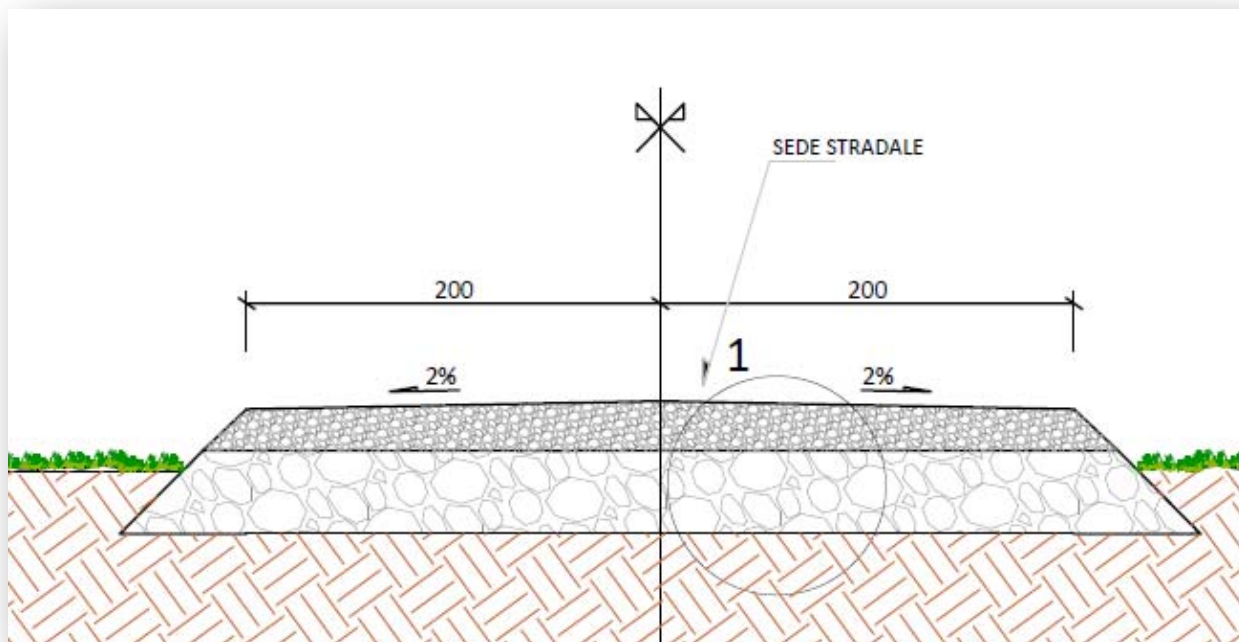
Estratto elaborato A.12.a.17 – Sezione stradale tipo
